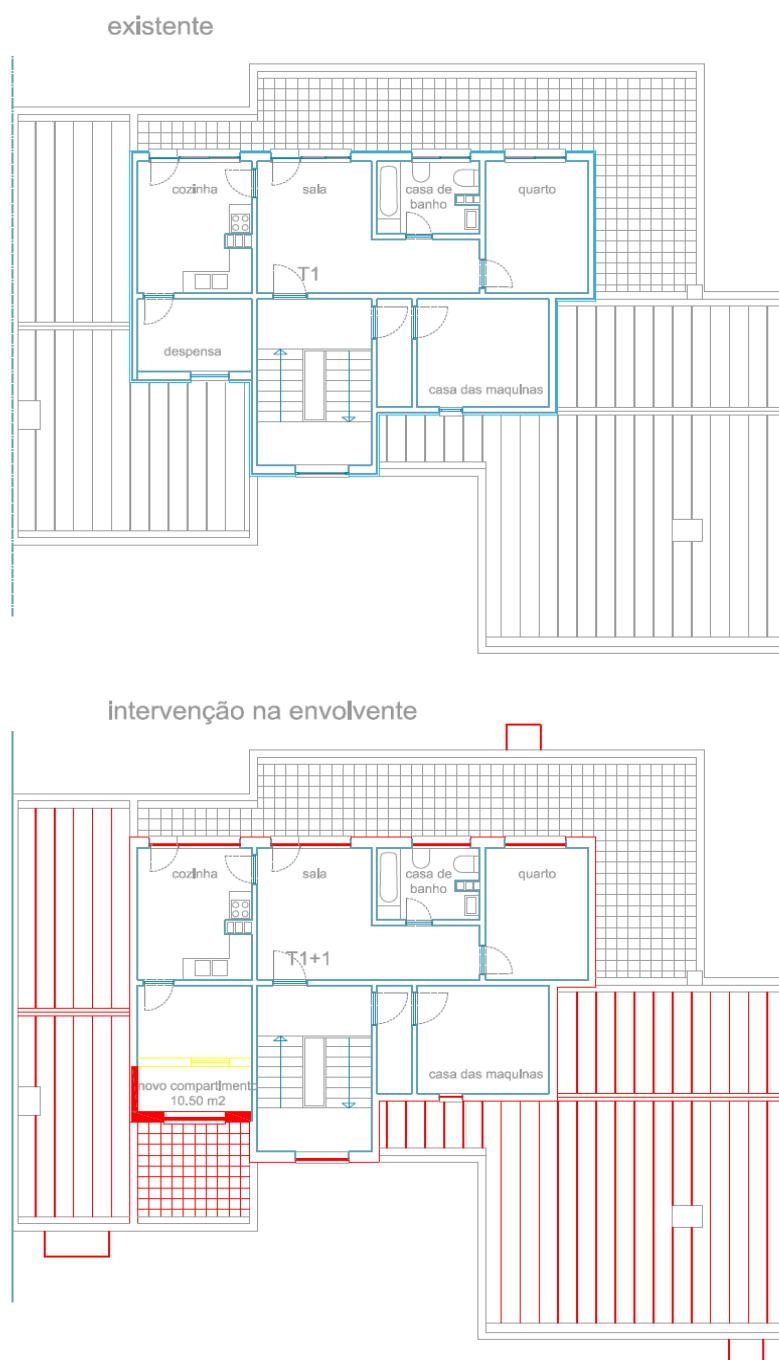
Tipologia “topo”. Planta do terraço (escala 1/200).
